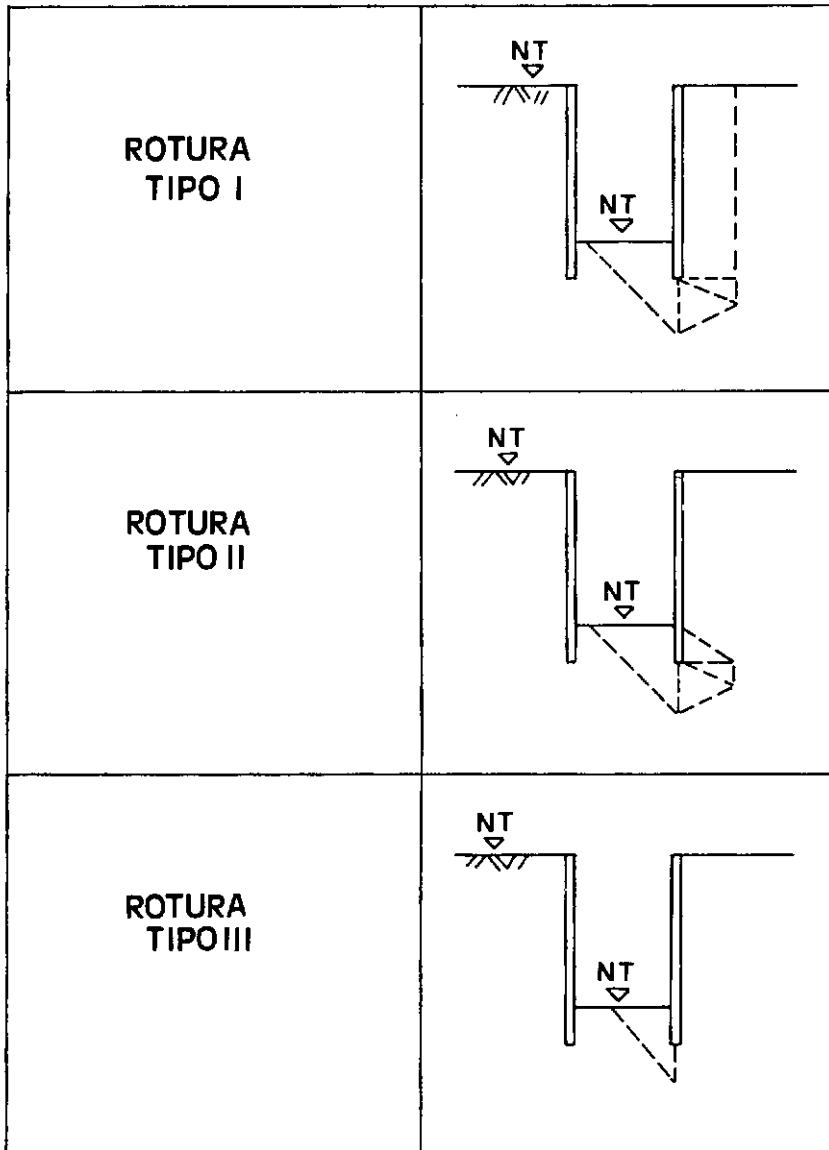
Tipos de Roturas , EHRlich (1987).
